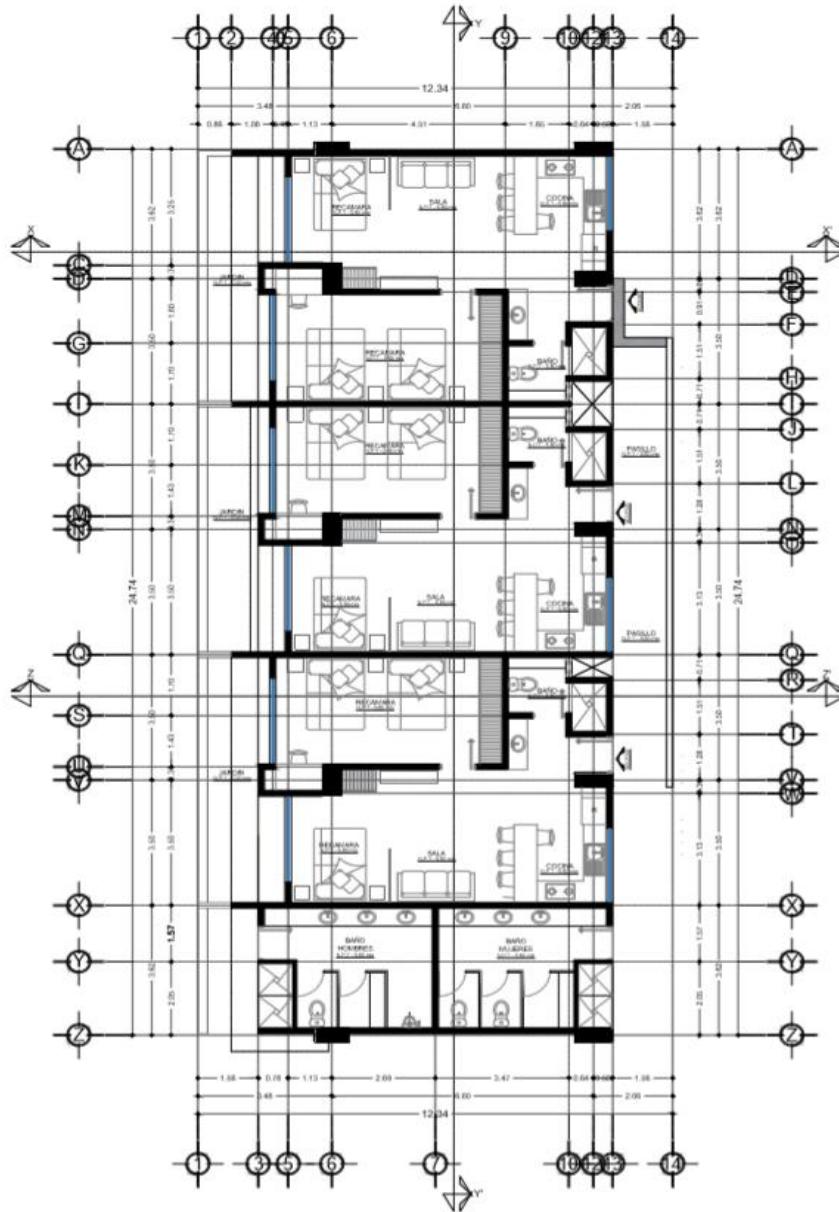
Planta arquitectónica del Sótano 2 Edificio A.
